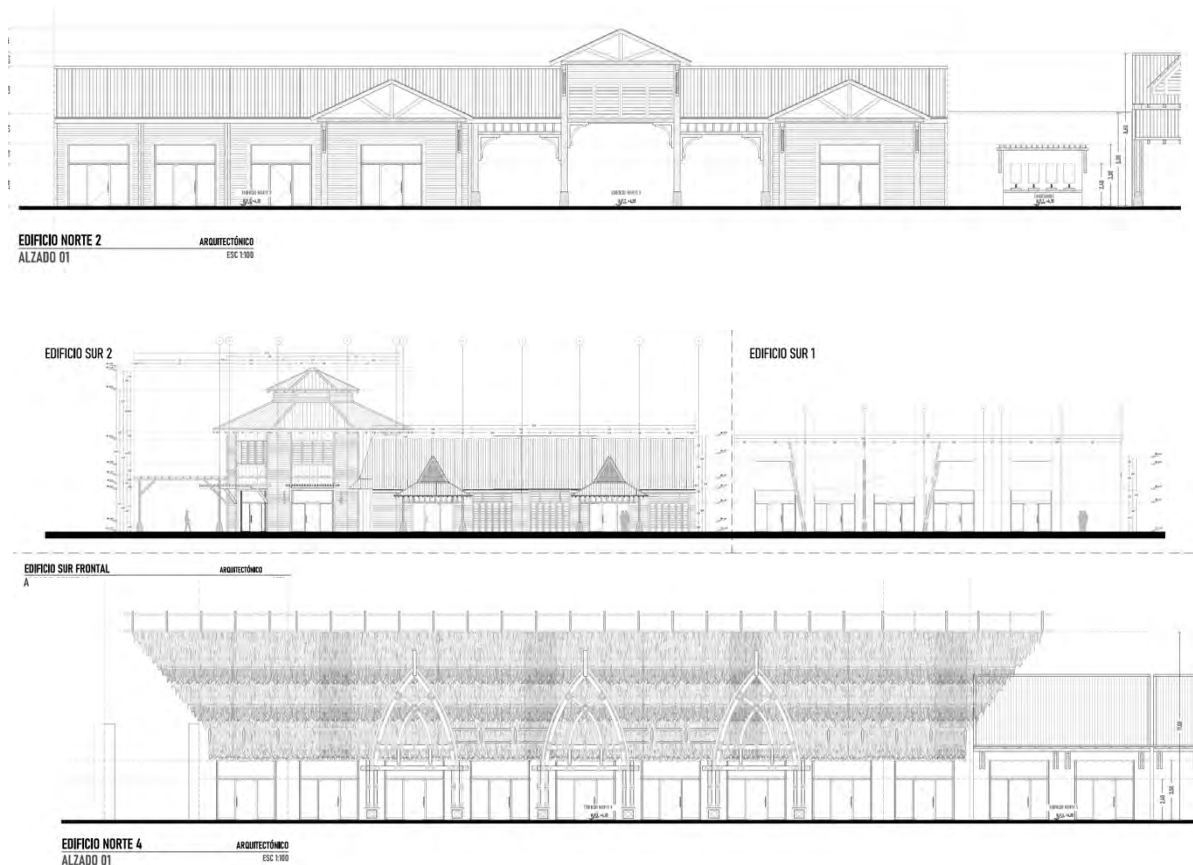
Alzados de las edificaciones correspondientes a restaurantes y locales de la plaza de acceso.
